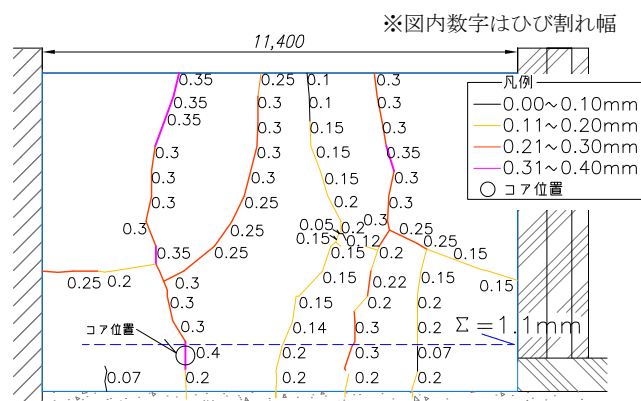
左側側部低拡散層ひび割れ図(材齢812日)
